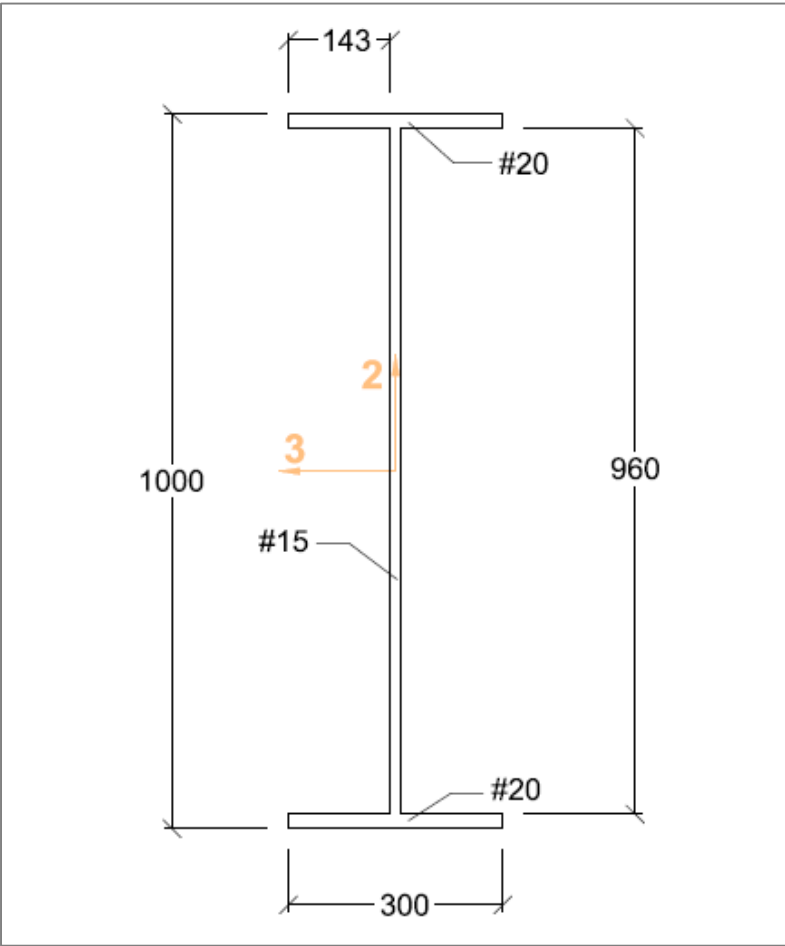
Sección vigas de piso de calzada en centro luz (cotas en mm).
